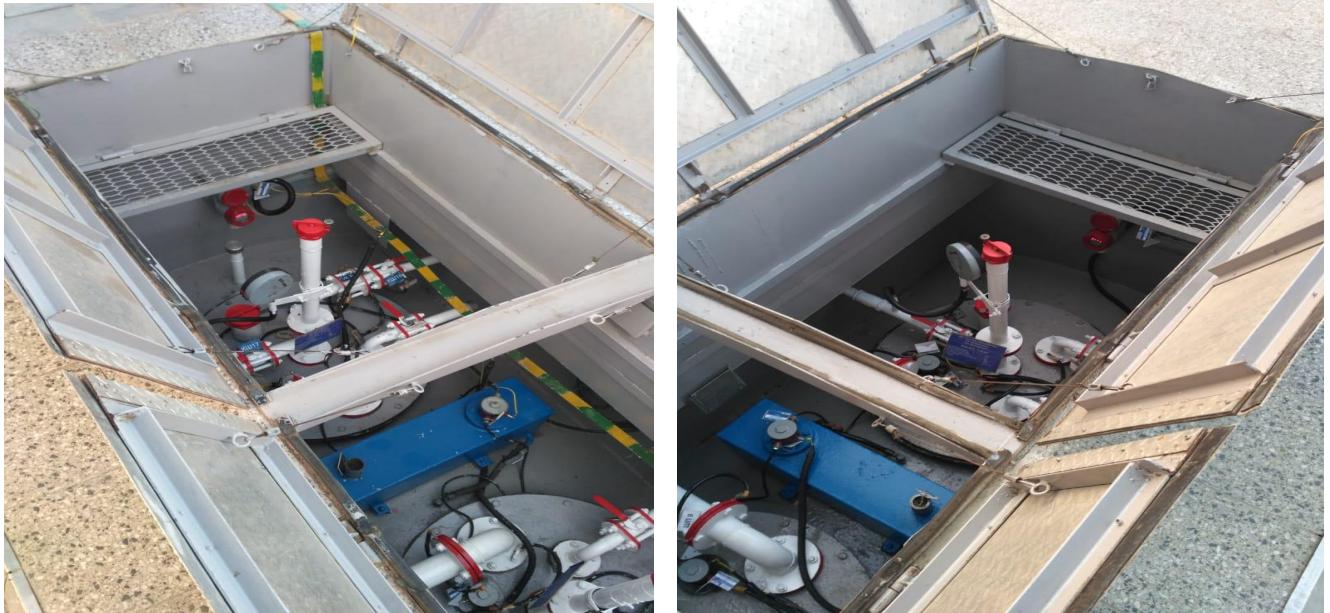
Общий вид видимой части конструкции резервуаров РГСД-25 №№ 610, 611
